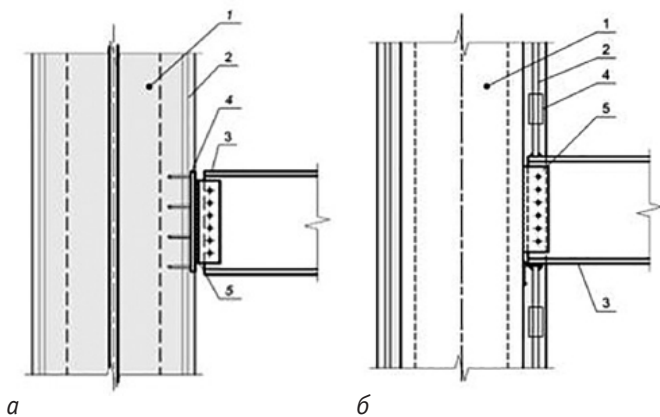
Примеры примыкания стальной балки к сталежелезобетонной колонне
